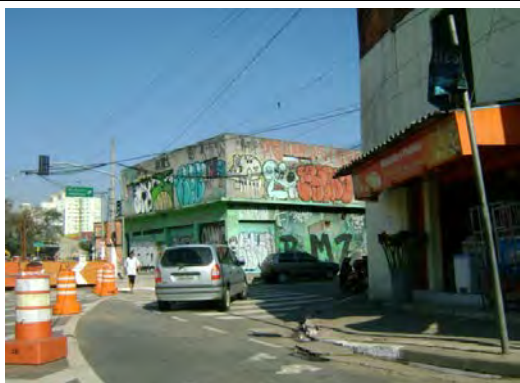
Vista para a área a ser desapropriada
